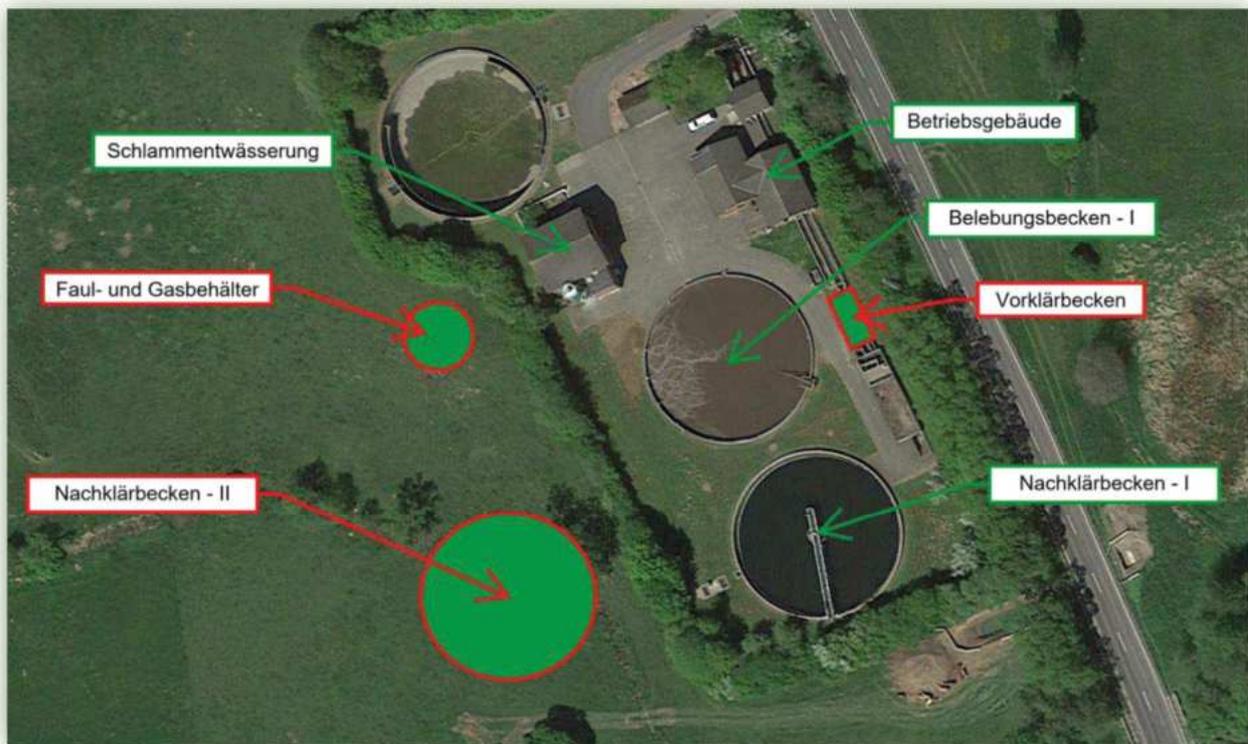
Lageplanskizze Variante 1 mit Faulbehälter
